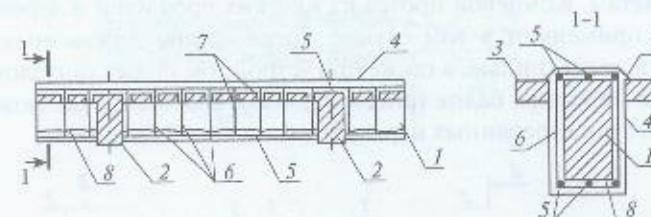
Усиление балок монолитного железобетонного перекрытия устройством железобетонной обоймы:
